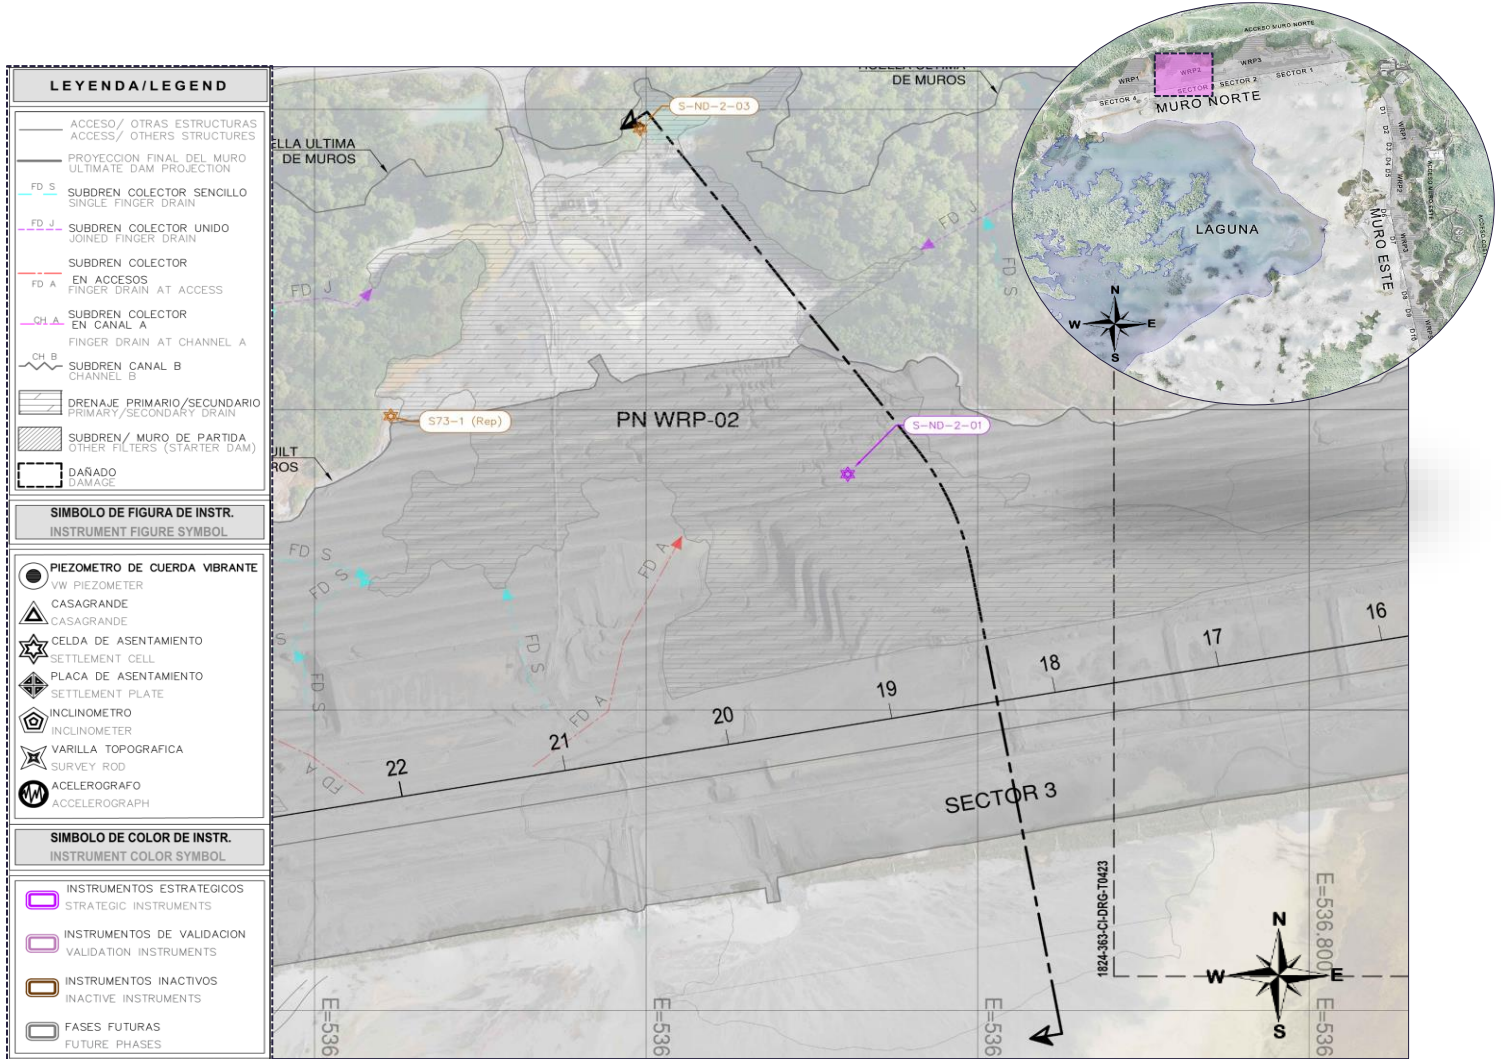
Vista de Planta en el Sector 3 - WRP2 con las Celdas de Asentamiento
